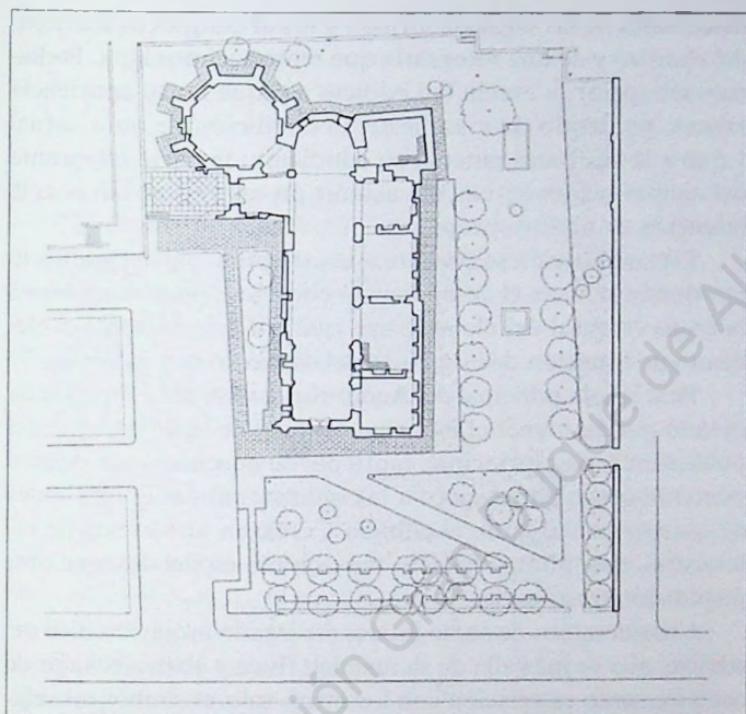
Planta del edificio y entorno antes de intervenir (José Ramón Duralde).
